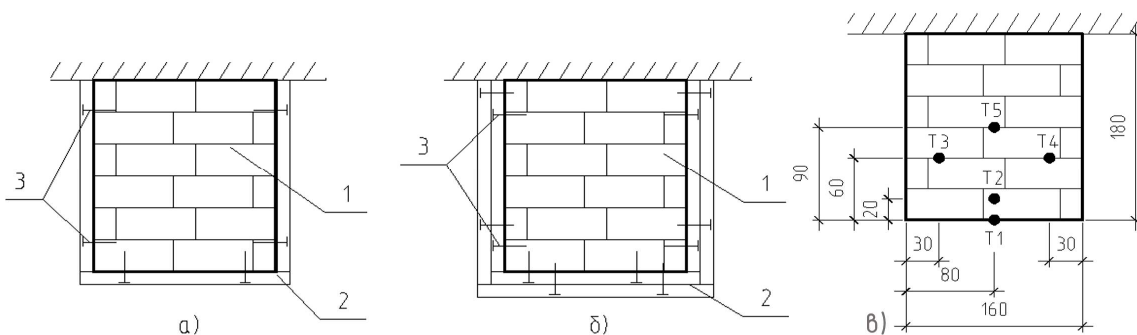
Поперечний розріз дерев'яних елементів захищених гіпсокартонними листами: а) зона А – один шар гіпсокартону; б) зона В – два шари гіпсокартону; в) схема розташування термопар в перерізі незахищеного дерев'яного елемента.
